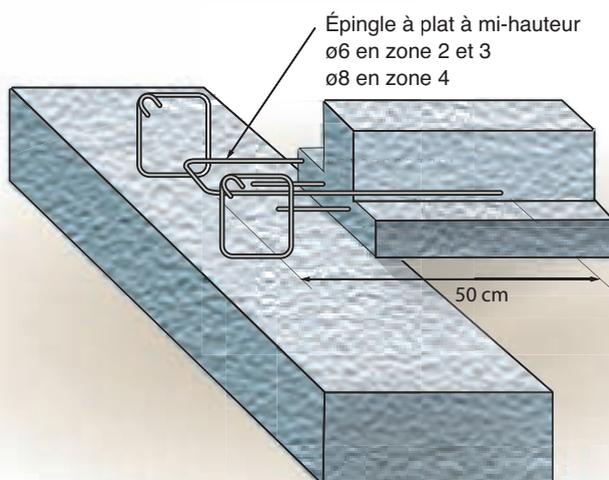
Ancrage des poutrelles en béton dans le chaînage
